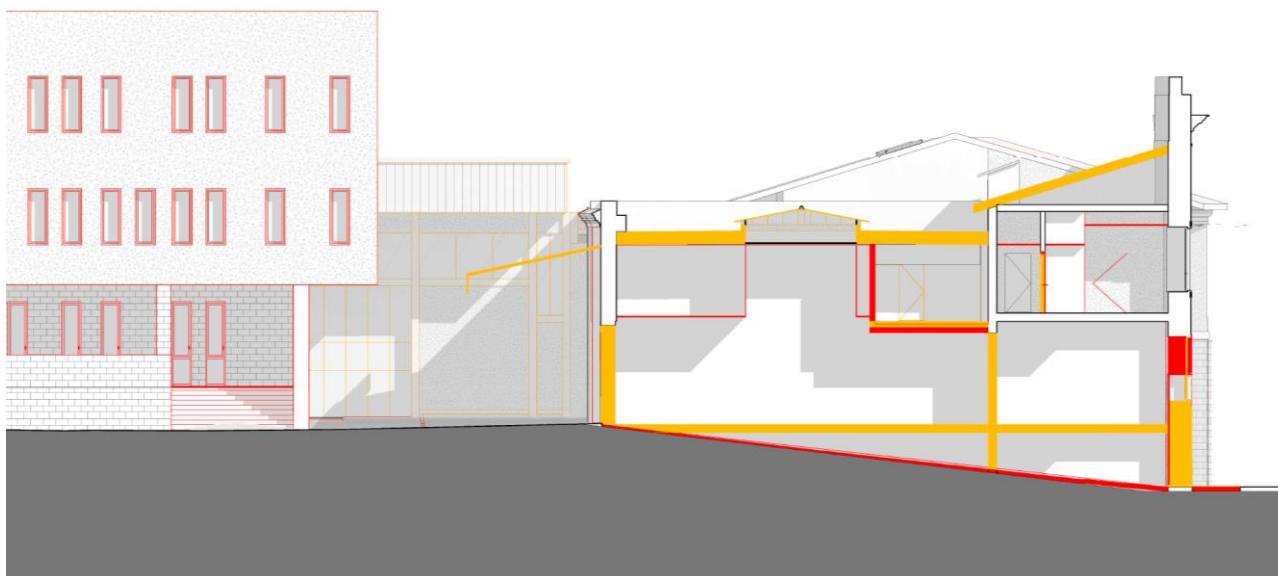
estratto della tavola del progetto sovrapposto – sezione trasversale lungo la nuova rampa d'accesso
